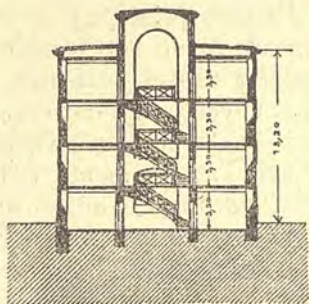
Sezione di un fabbricato per celle coperto da tetto piano.
